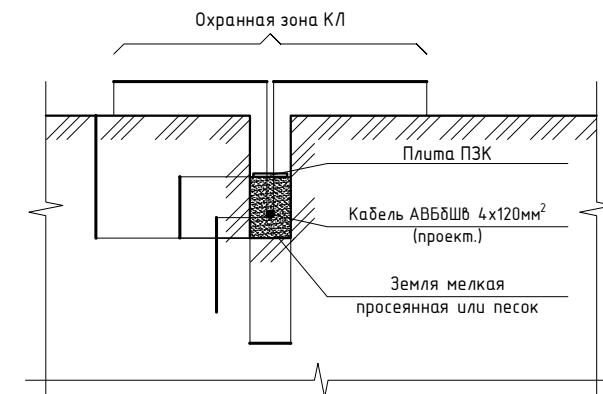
Поперечный разрез кабельной траншеи с 1 КЛ
